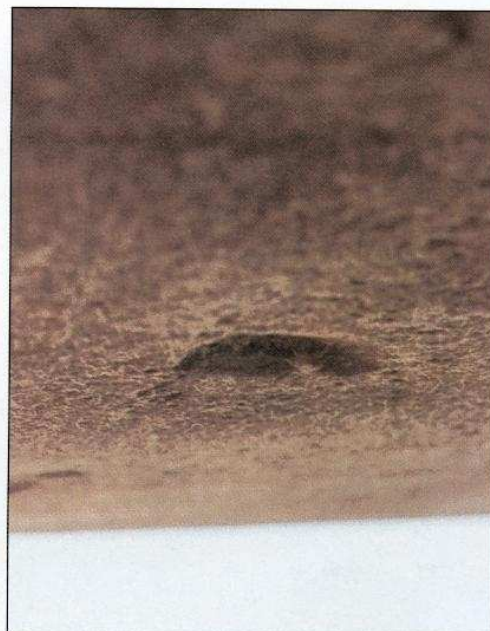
surface lisse signe d'un délaminage de la couche dure
